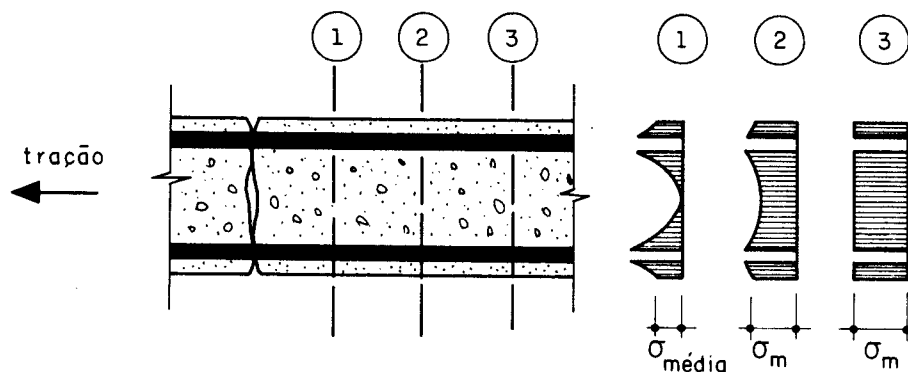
Distribuições de tensões na massa de concreto fissurado.
